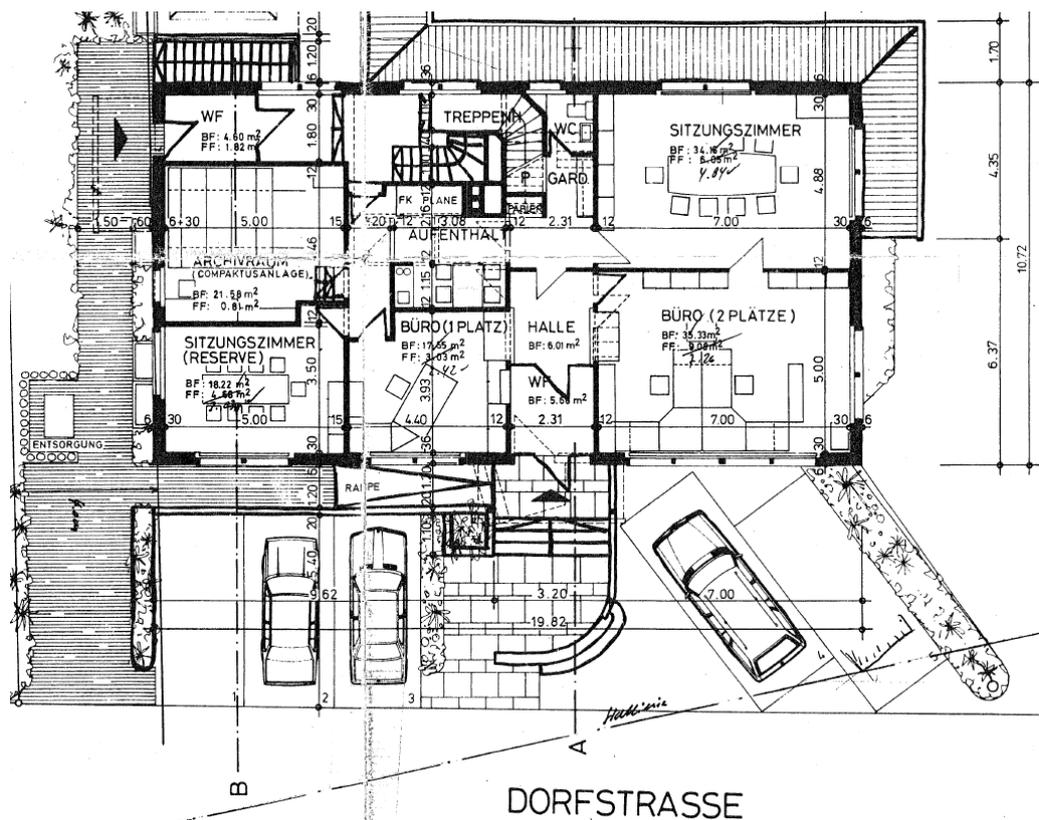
Bestandesplan Erdgeschoss, Massstab 1:200
